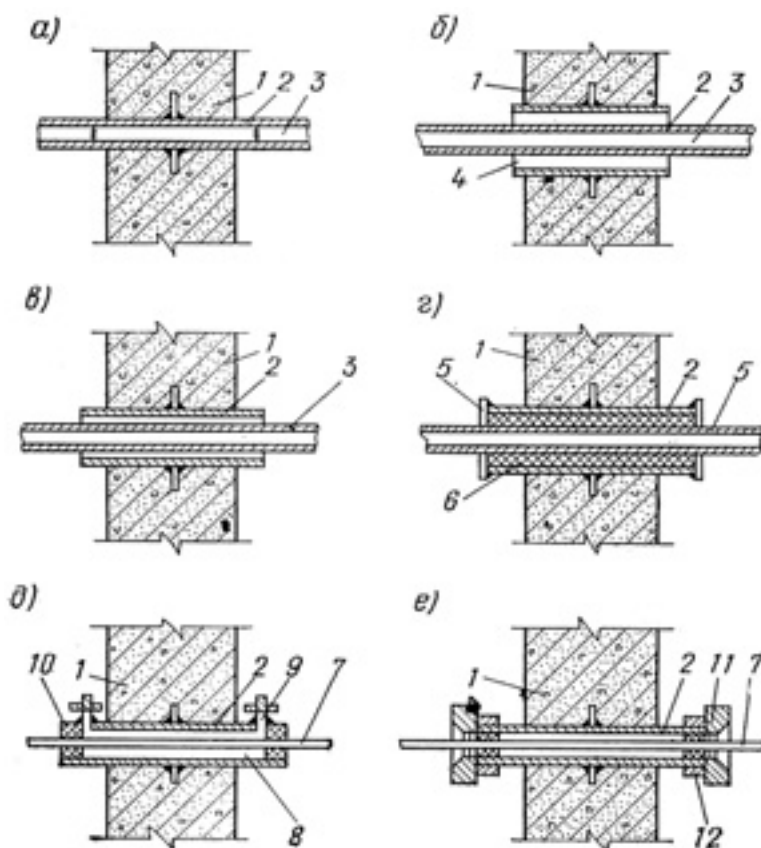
Закладные части герметизирующих устройств на вводах трубопроводов и кабелей: а — для воздухопроводов и холодных труб с приваркой встык (на внутренних линиях герметизации); б, в — для холодных труб с пропуском внутри закладной гильзы; г — универсальный ввод для всех трубопроводов; д, е — то же, для кабелей и электропроводов; 1 — кольцевое стальное ребро; 2 — закладная гильза; 3 — трубопровод; 4 — зачеканка цементным раствором; 5 — стальной приварной фланец; 6 — набивка асбестом; 7 — кабель или электрические провода; 8 — кабельная мастика; 9 — патрубок для заливки кабельной мастики; 10 — уплотнение просмоленным канатом; 11 — гайка сальника СКТ; 12 — упругая подкладка
